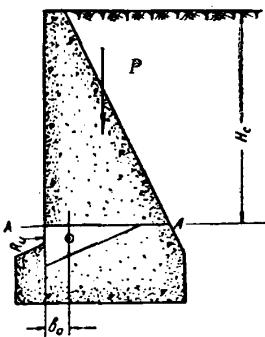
К поверочному расчету устойчивости бетонных подпорных стен на опрокидывание
